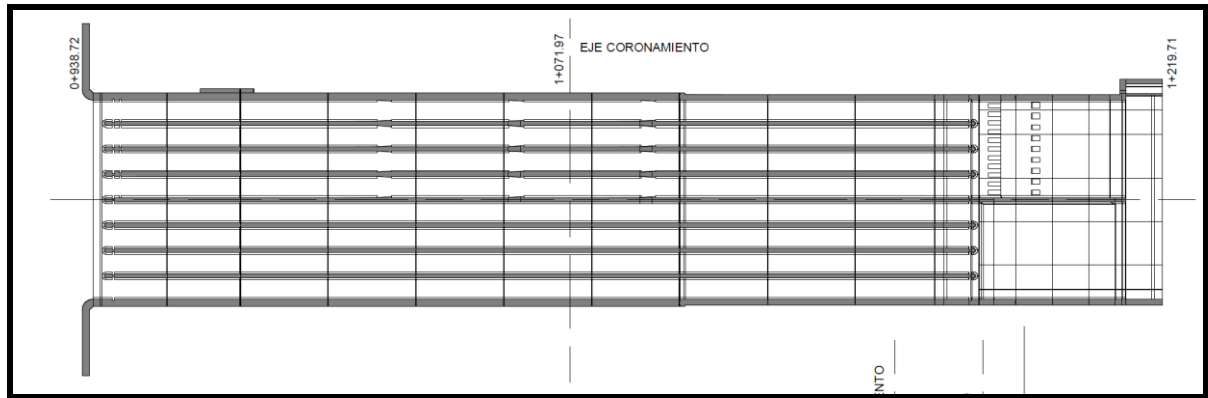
Planta y corte de la estructura de desvío/descargador de fondo
